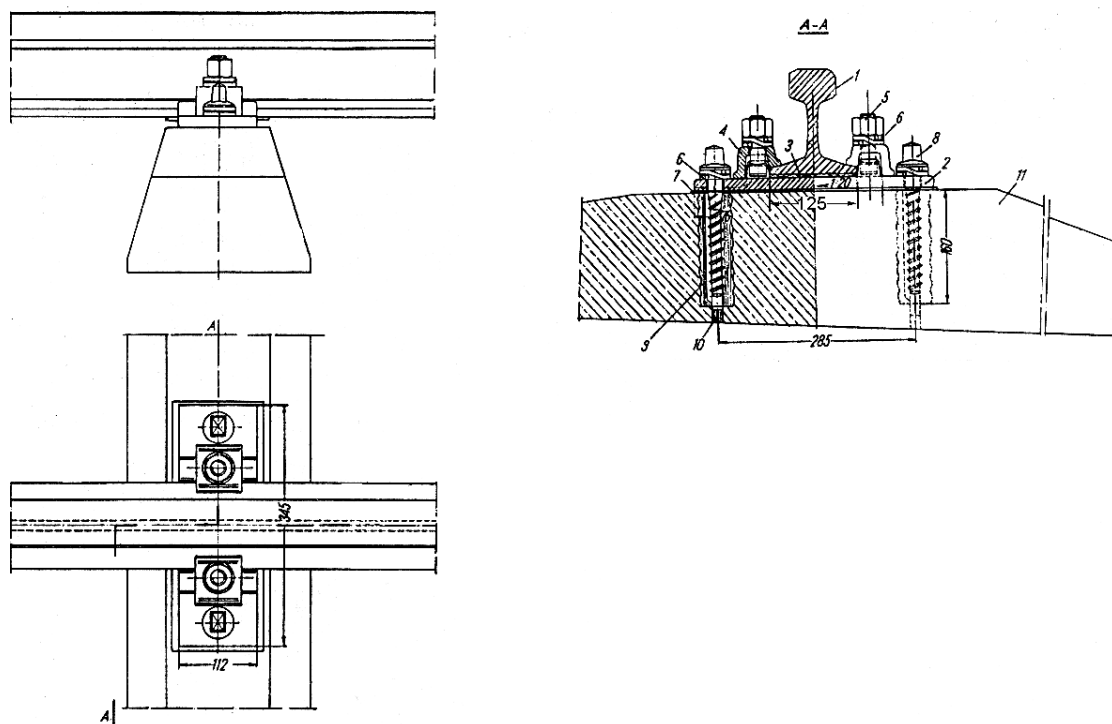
Przytwierdzenie typu SB szyny UIC60(60E1) do podkładów betonowych
